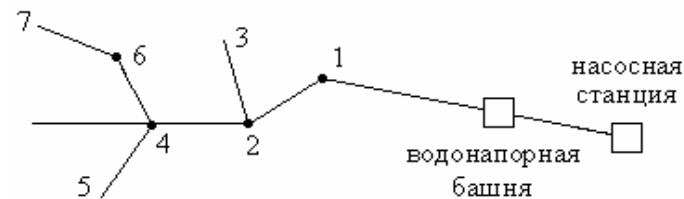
Расчетная схема тупиковой водопроводной сети, для животноводческой фермы (комплекса).
